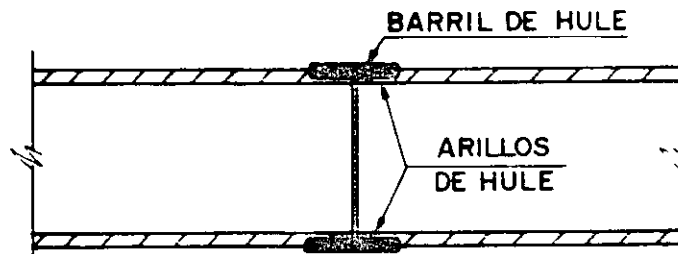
UNION EN TUBERIAS DE ASBESTO - CEMENTO
